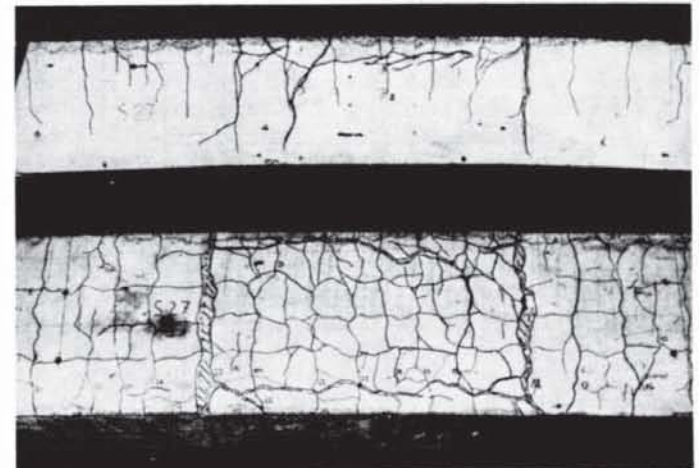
Bruchbild eines Übergreifungsstoßes bei einer die Stöße umschließenden Querbewehrung (nach [13])
